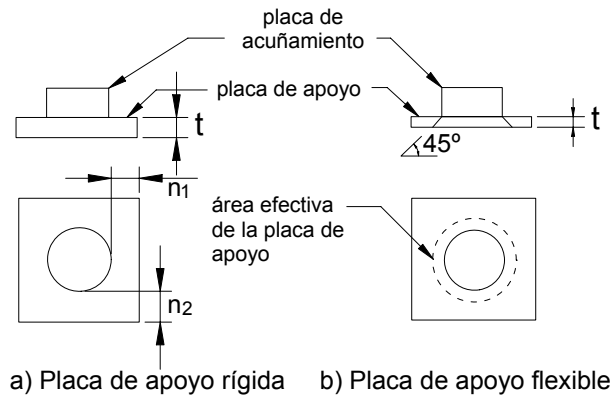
Área efectiva de la placa de apoyo para dispositivos de anclaje con placa de acuíñamiento separada
